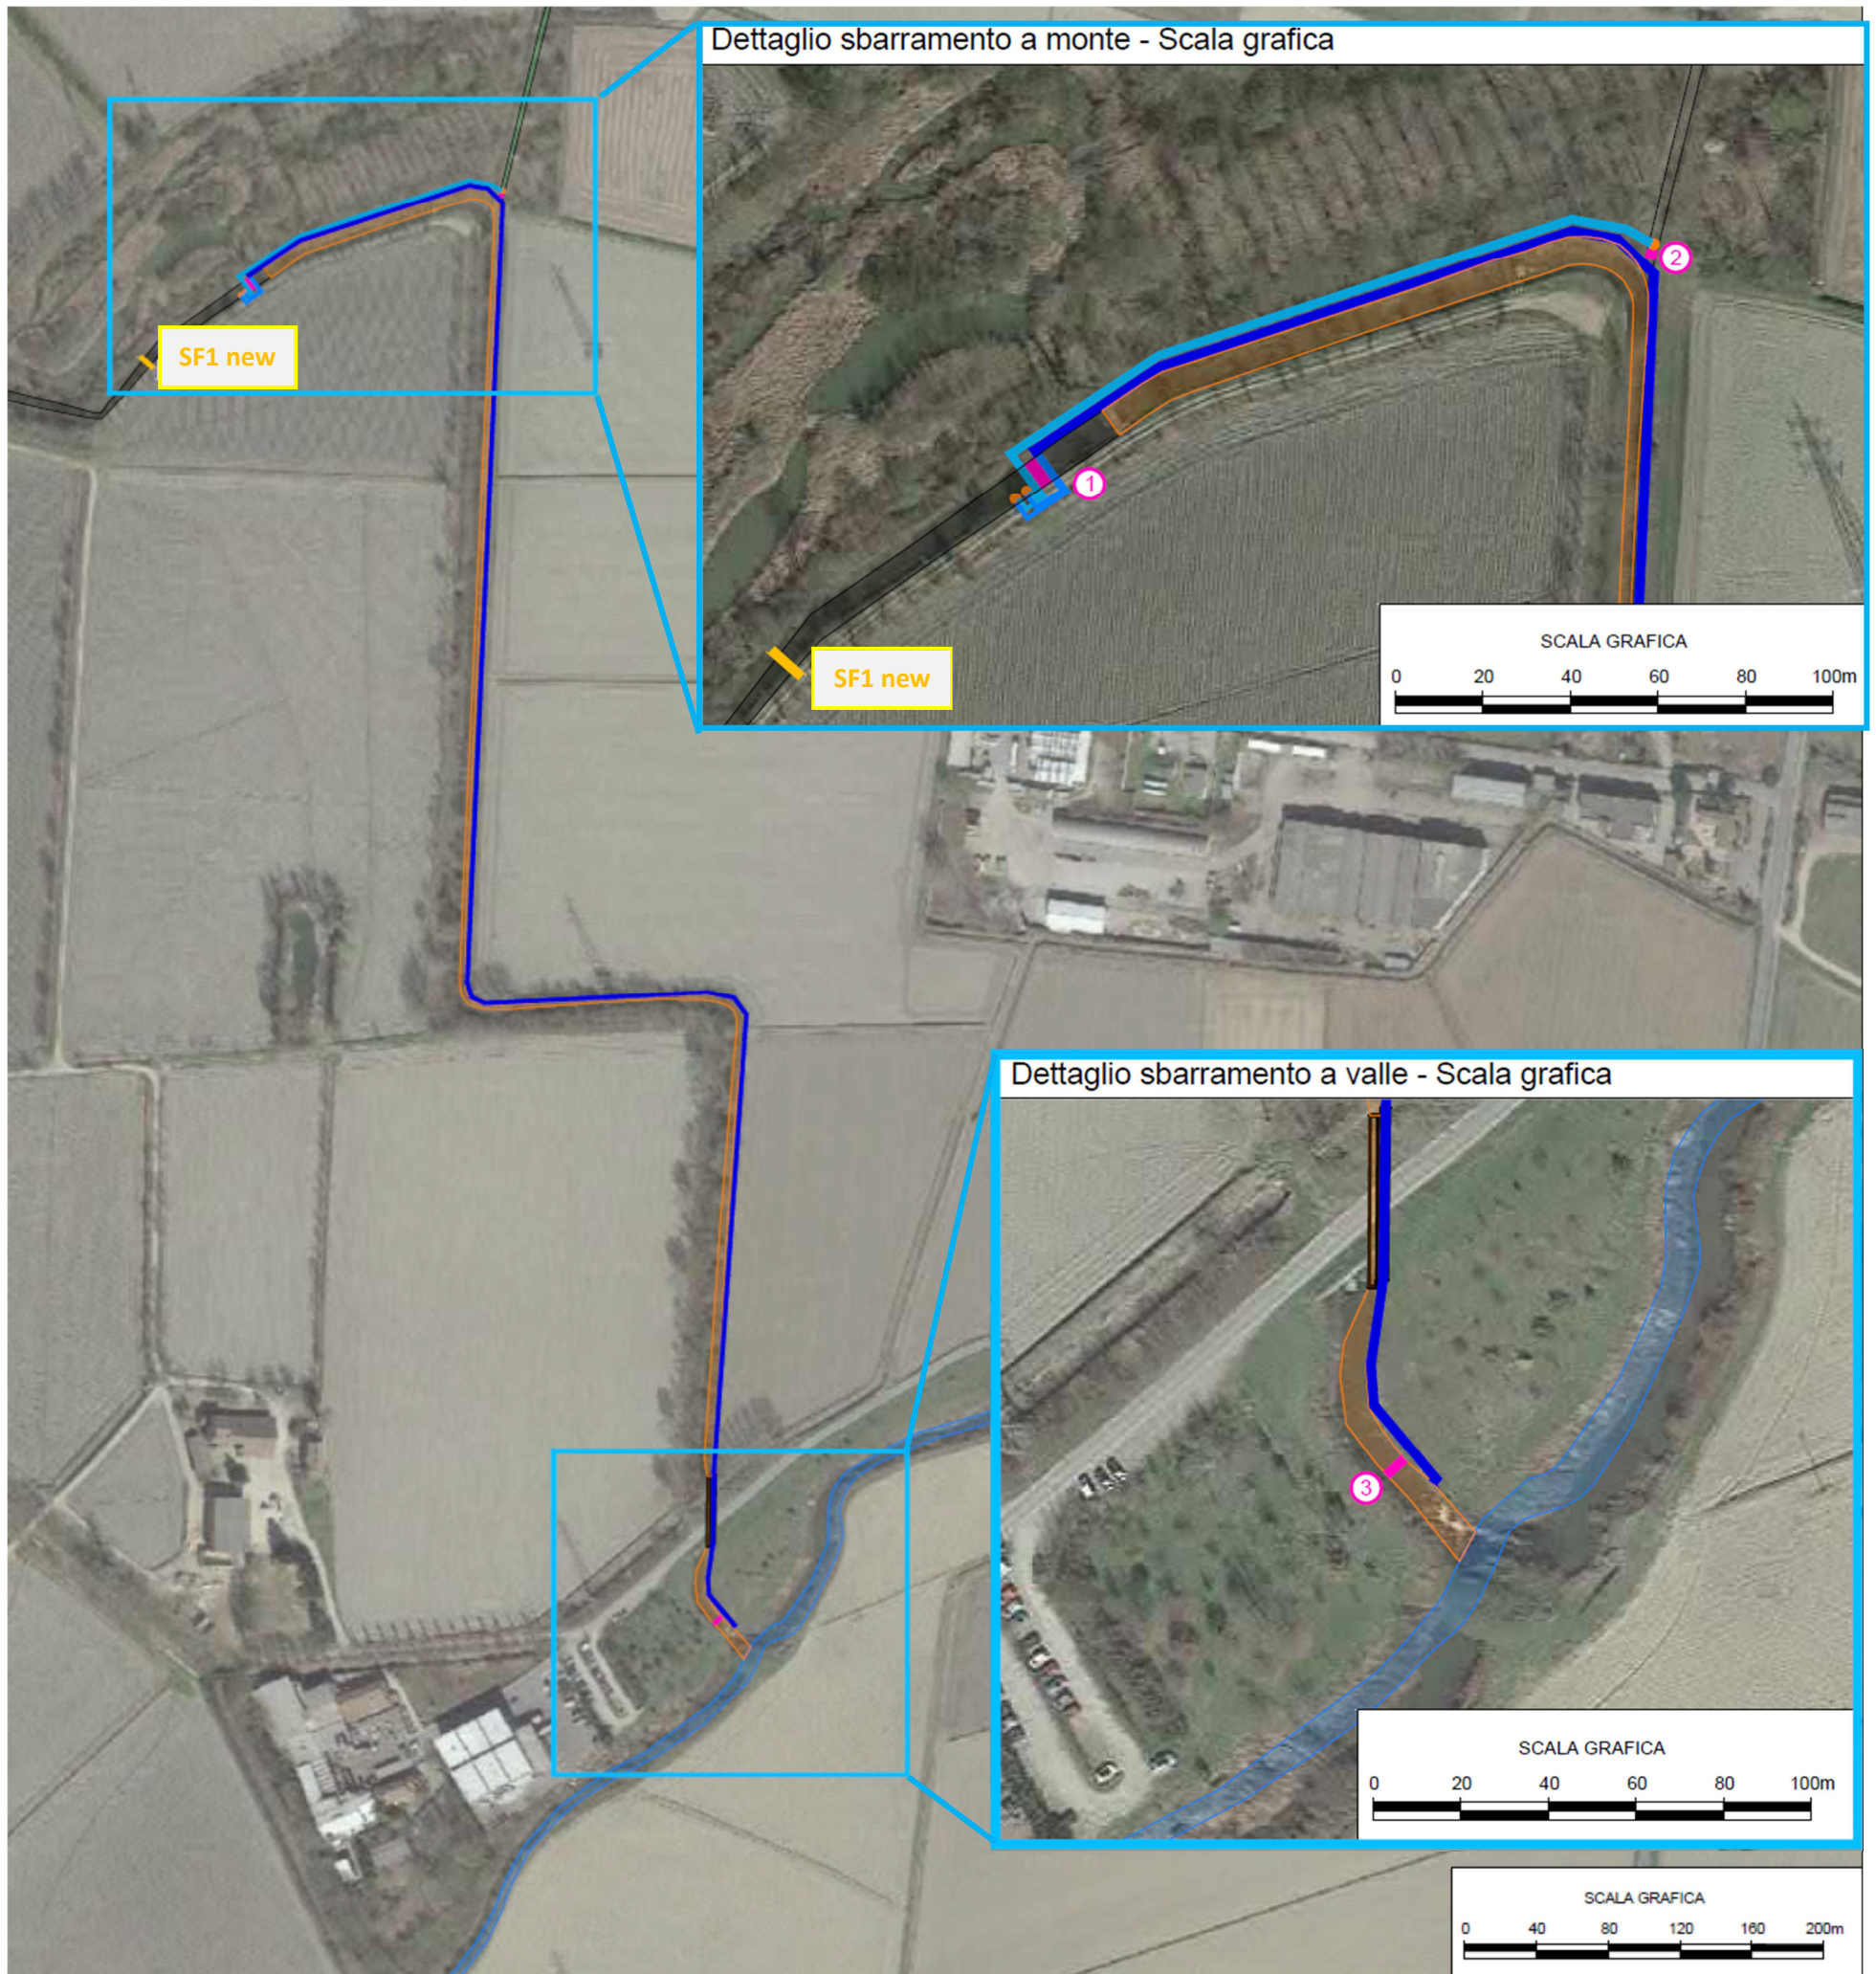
Planimetria di progetto- ubicazione degli interventi di modifica
